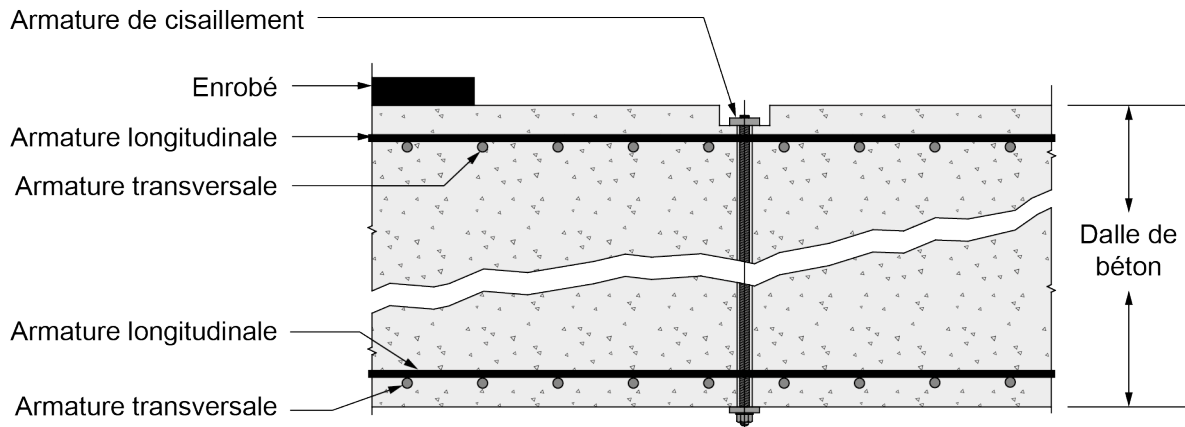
Ajout d'armatures de cisaillement – exemple type
